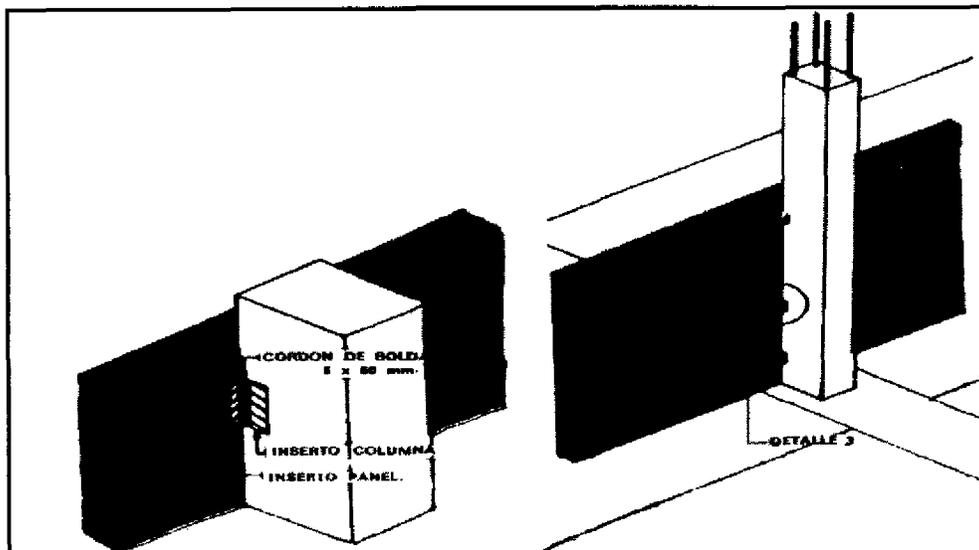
Detalle de unión de elementos no estructurales y estructurales.
